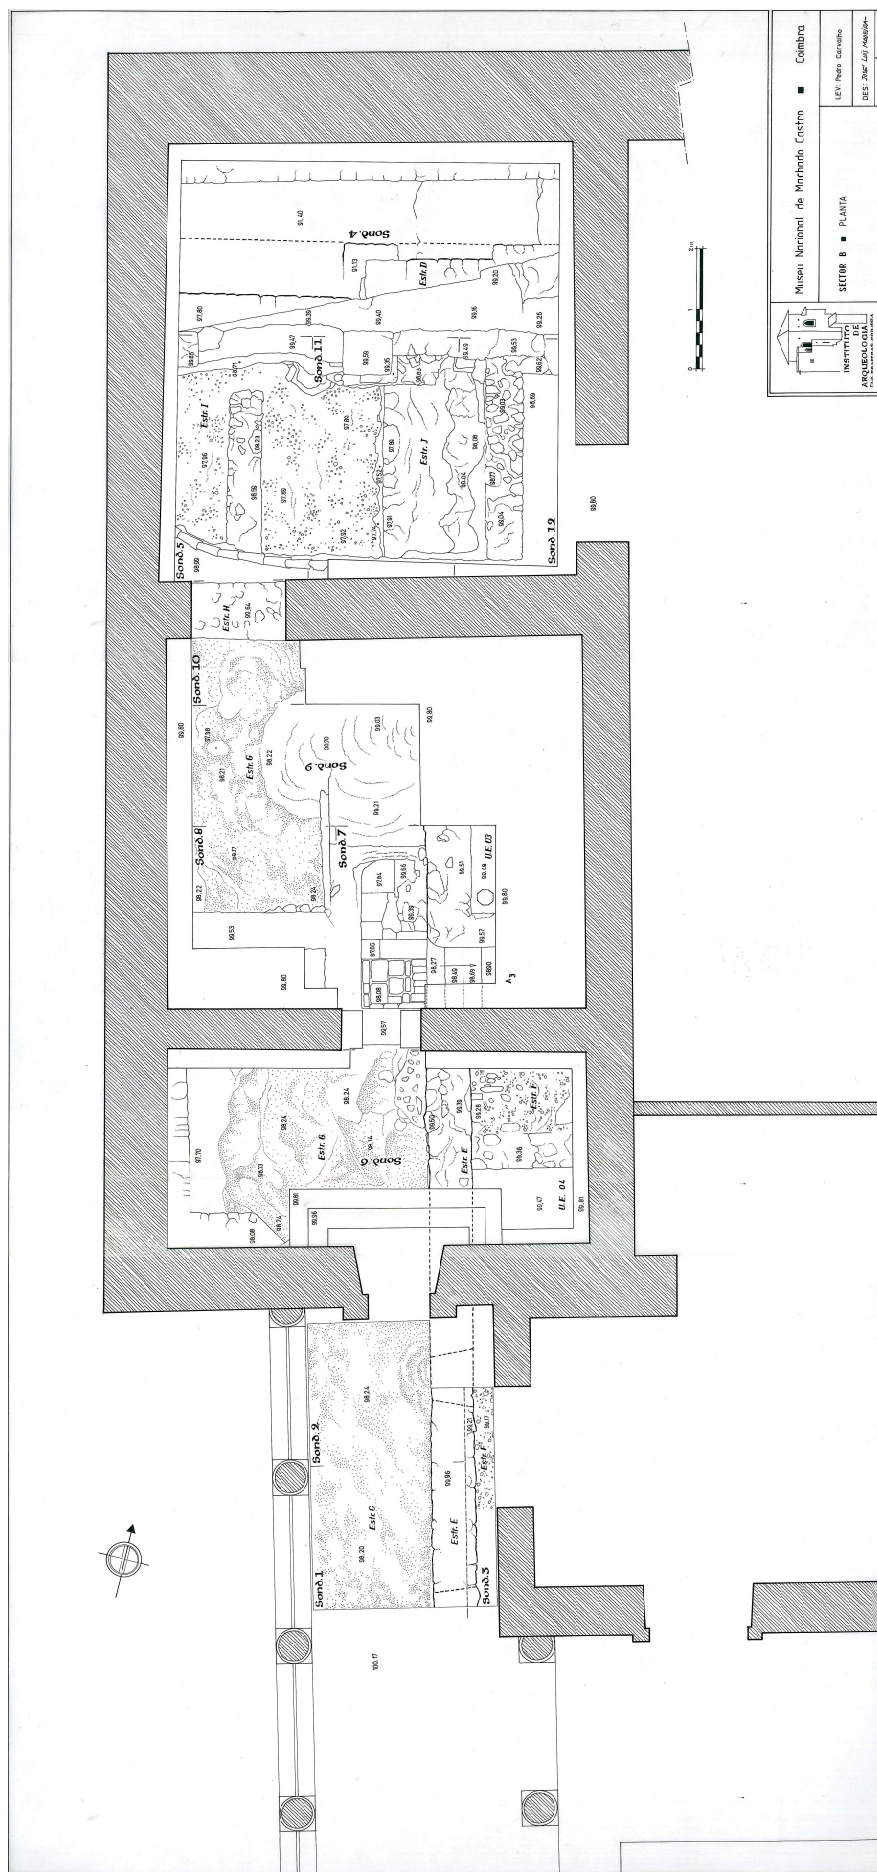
Localização das sondagens e planta das estruturas identificadas no sector B da campanha arqueológica de 1992-98 (retirado de Carvalho, 1998: planta 27).
